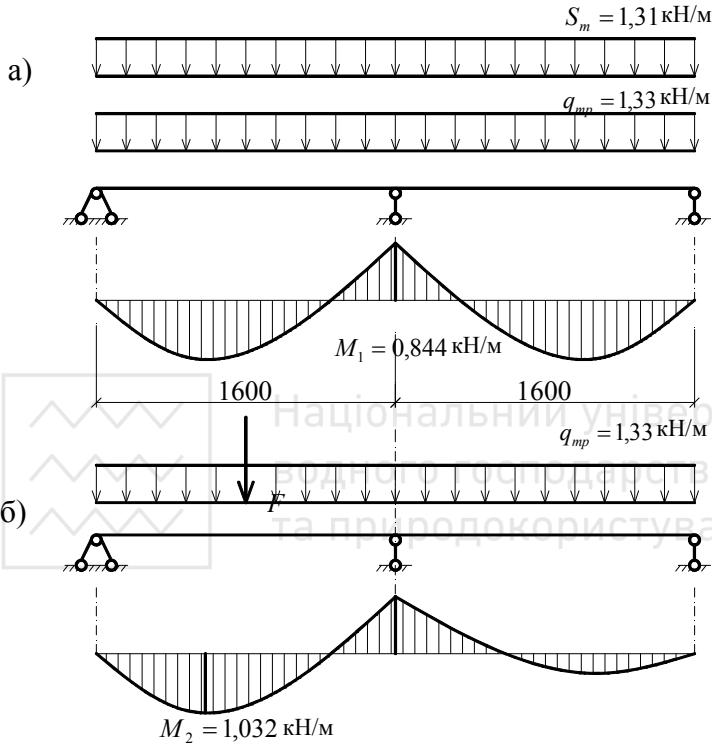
Розрахункова схема щита: а) – для першого сполучення навантажень; б) – для другого сполучення навантажень
